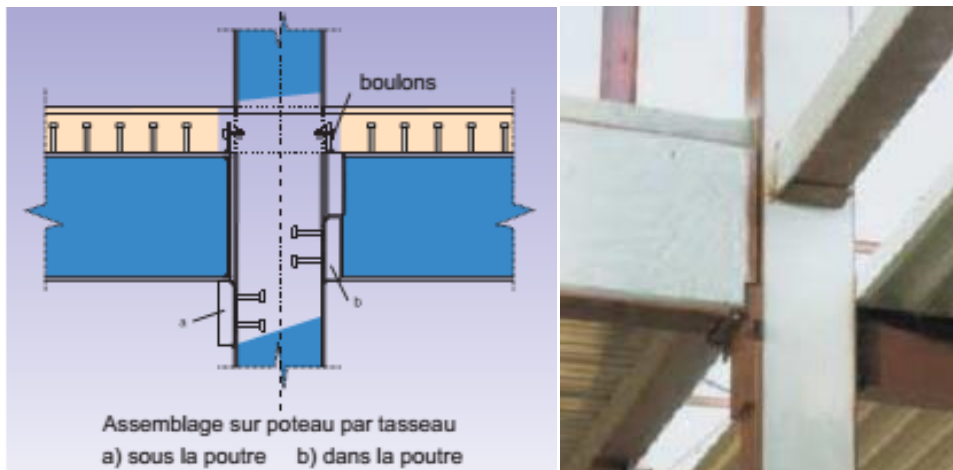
Assemblage poutre-poteau par tasseau [7].
